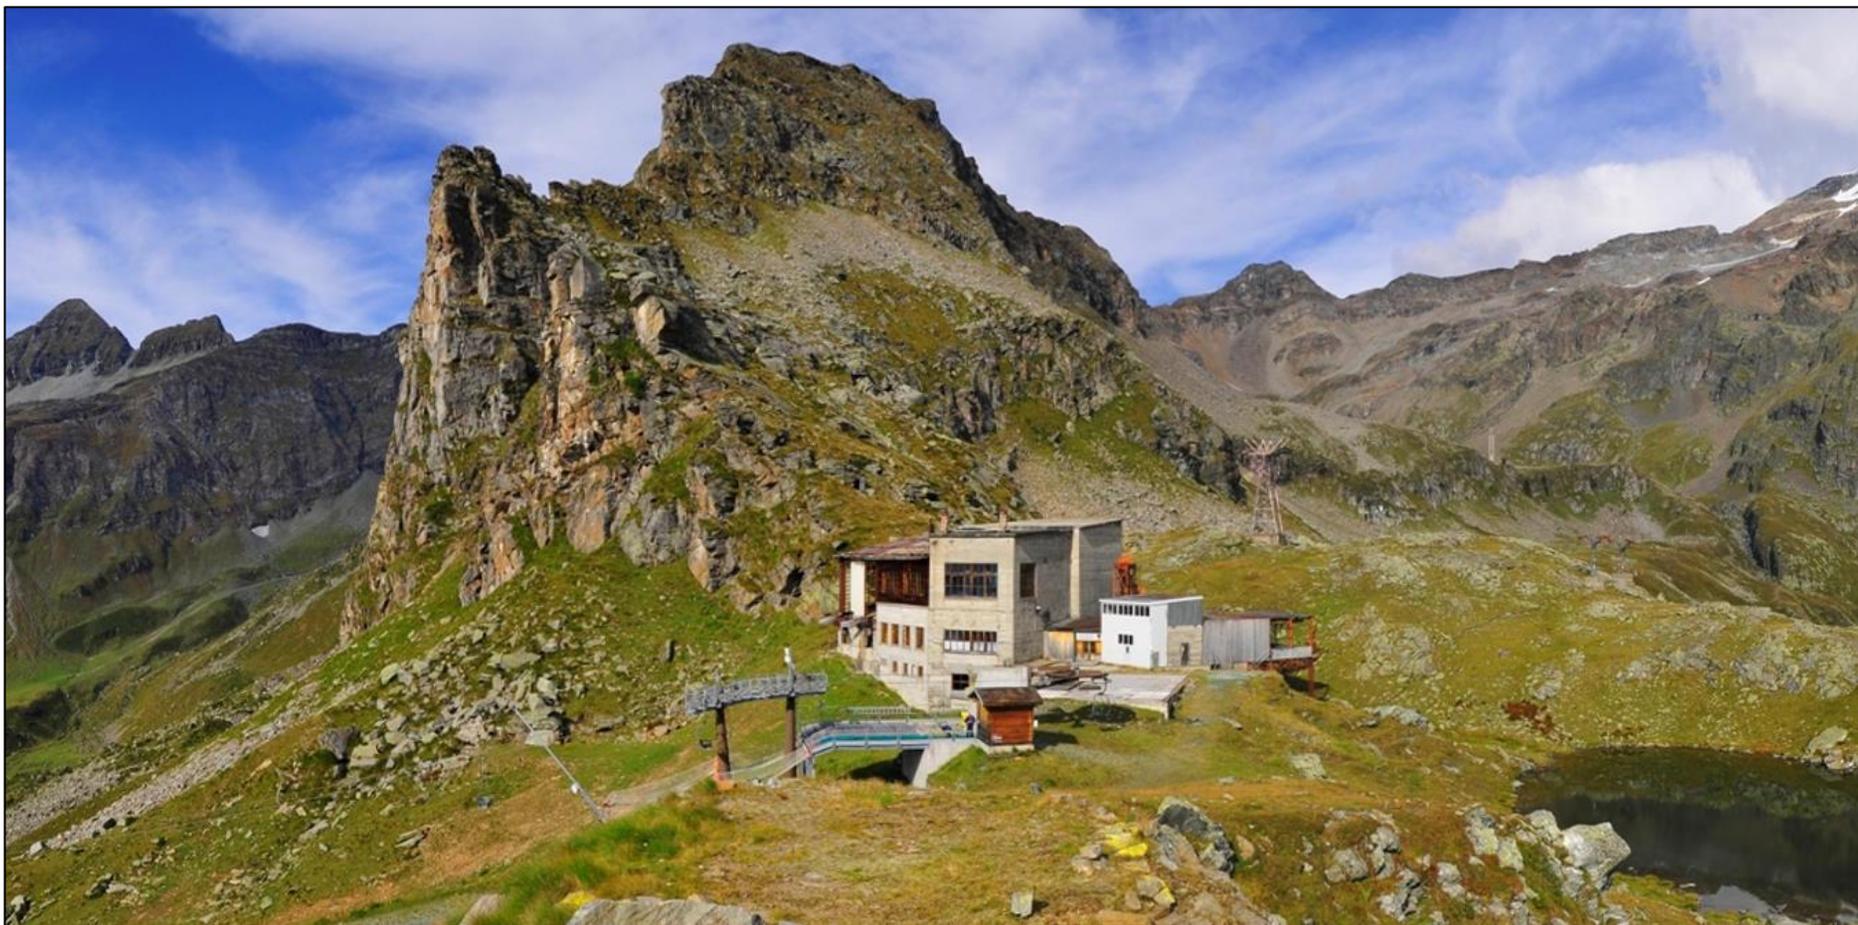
Stazione di valle Bocchetta delle Pisse – Fronte lato Pianalunga – Rappresentazione delle opere in progetto e, sul retro dello smantellamento del Sostegno 1
